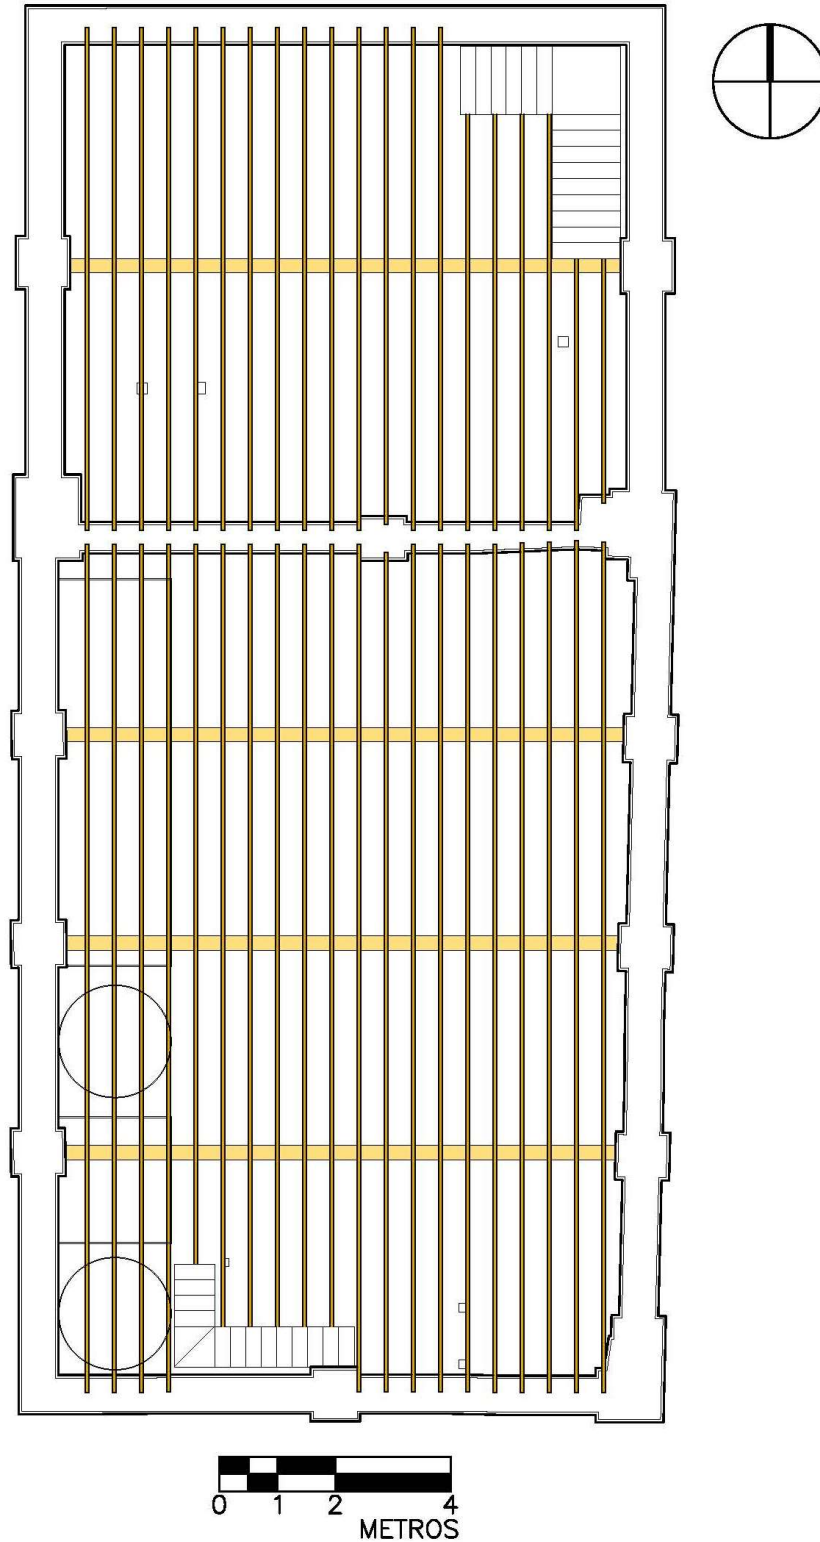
Levantamiento del estado actual. Las vigas están acomodadas una por una equidistantes entre sí, la distribución de las vigas principales sigue el ritmo de las columnas de los muros de tabique. Vigería en planta segundo nivel. Elaboración por M.A.R.C.
